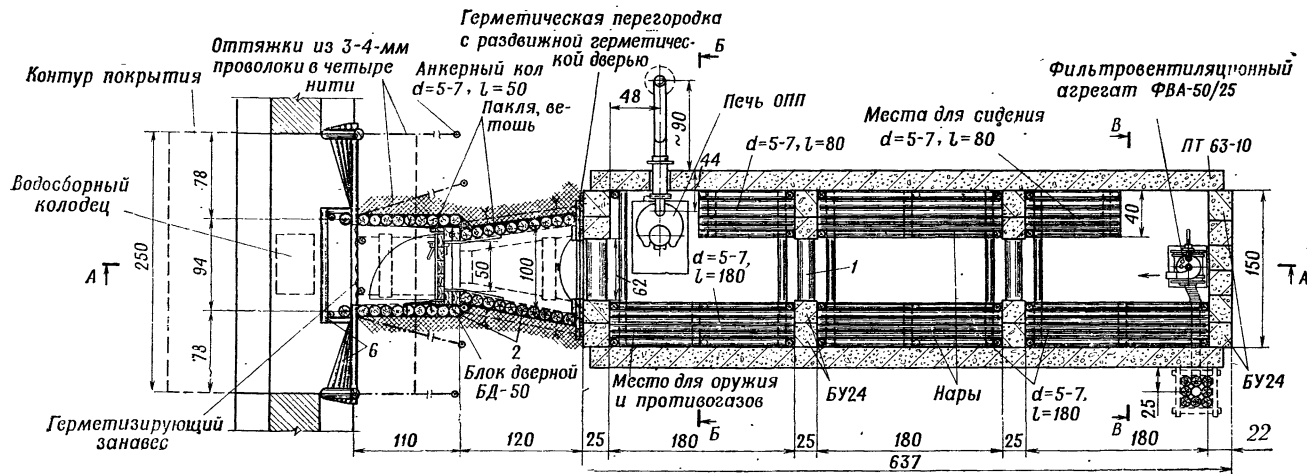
Убежище из железобетонных перемычек и панелей (план, разрез)
